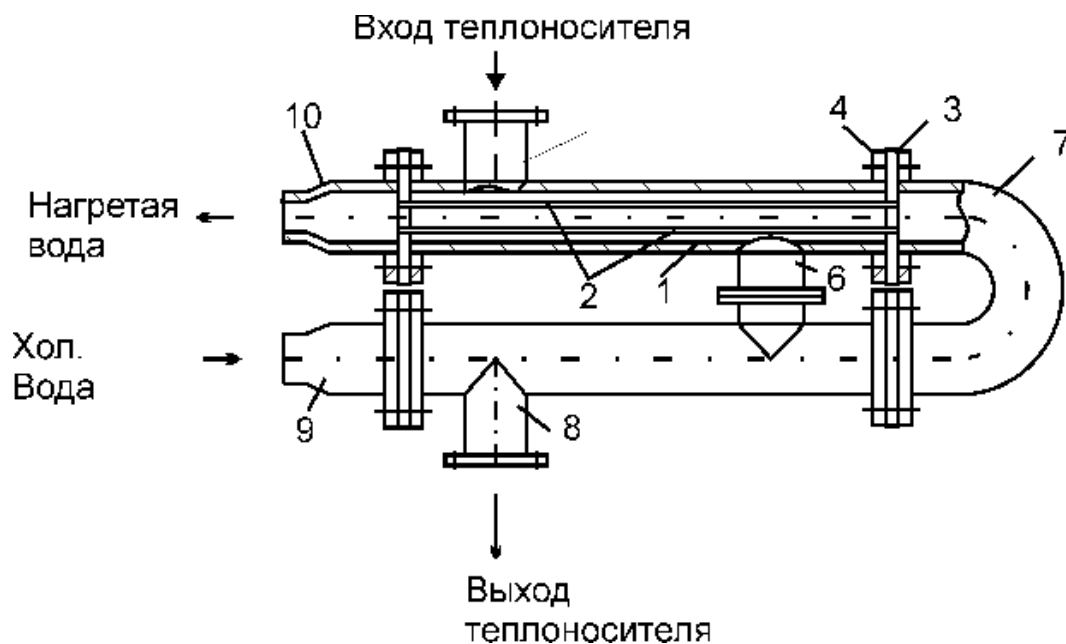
Водно-водяной подогреватель: 1 - корпус; 2 - трубки; 3 - трубные решетки; 4 - фланцы; 5 - патрубки входа теплоносителя; 6 - переключки; 7 - калач; 8 - патрубков входа теплоносителя; 9 - 10 - патрубки для воды.
